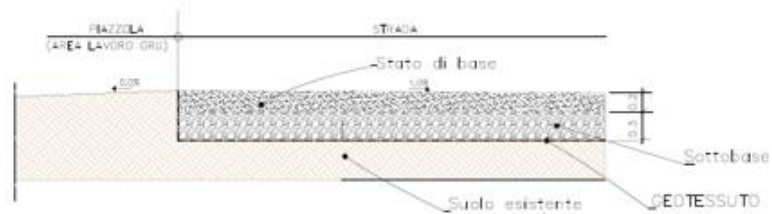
Sezione della piazzola (configurazione completa) in fase di cantiere
